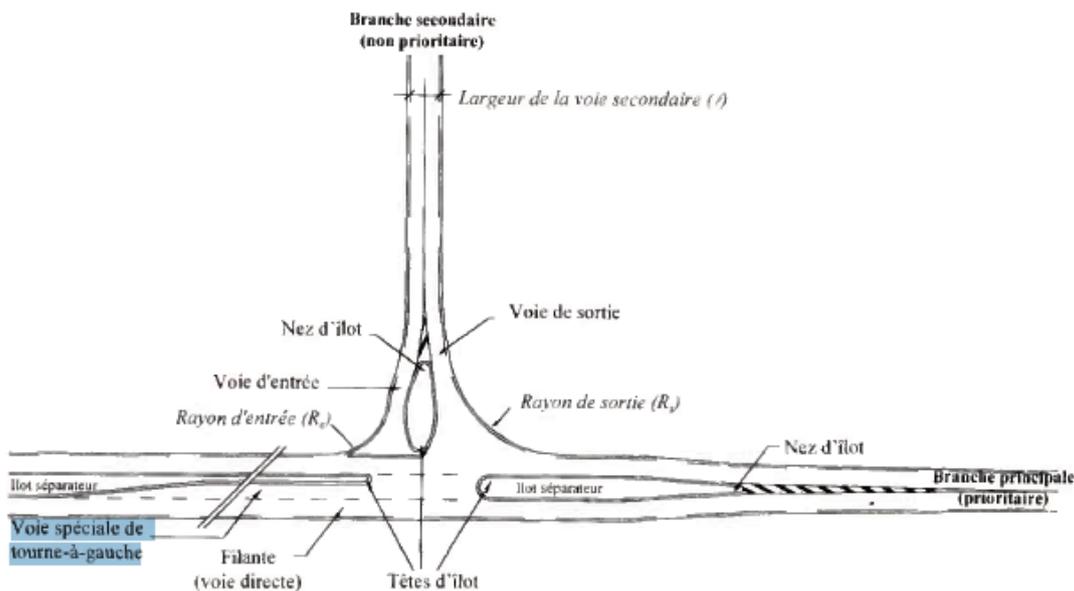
Localisation d'une voie de stockage sur un carrefour plan ordinaire (Source : Setra)
